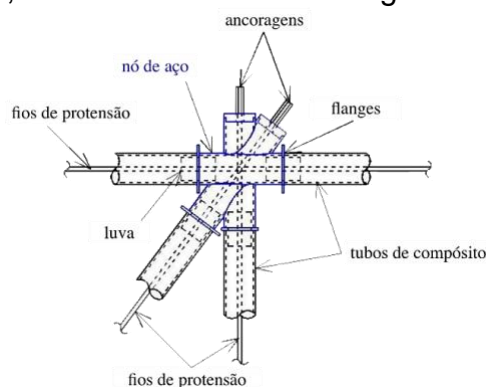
Detalhe tubo-nó da viga treliçada
